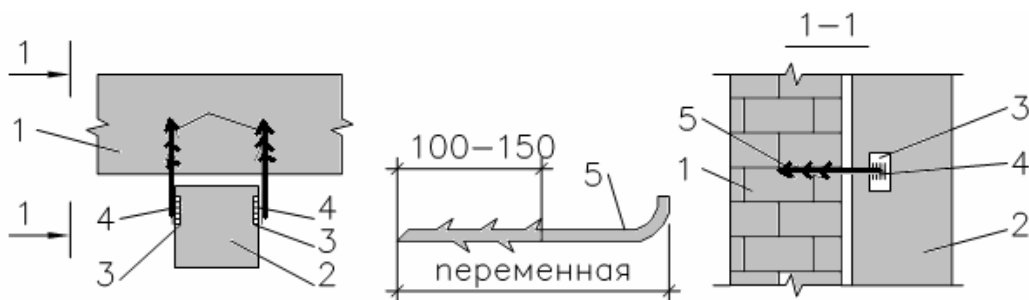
Восстановление сопряжений гибкими связями: 1 – продольная стена, 2 – железобетонная колонна, 3 – закладная деталь колонны, 4 – сварка, 5 – анкер
